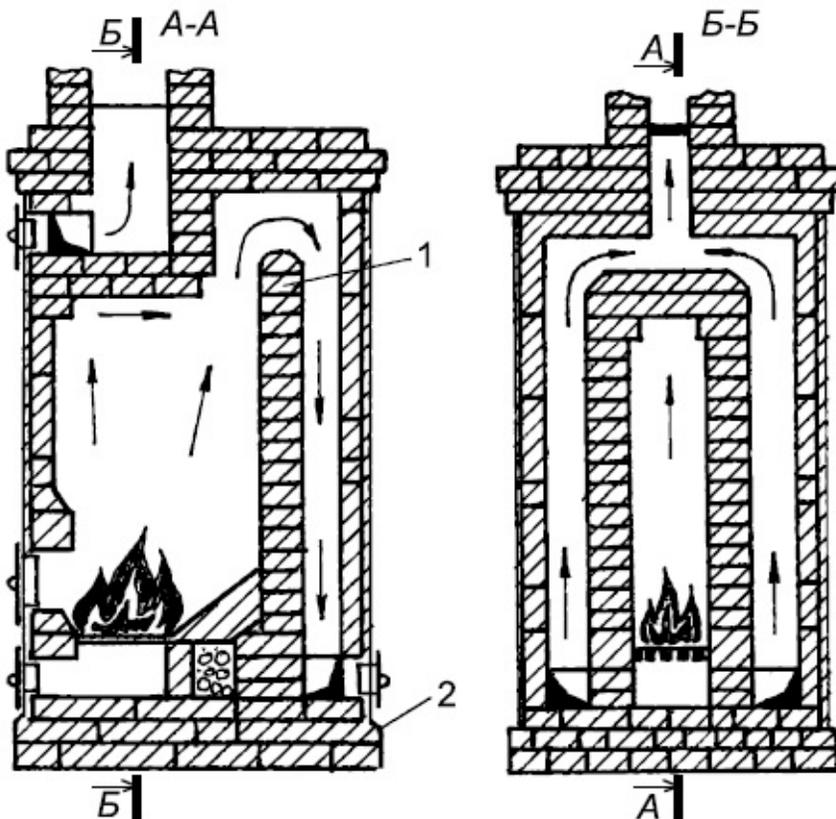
(окончание). Устройство отопительной круглой печи в металлическом футляре: 1 – перевальная стенка; 2 – цоколь
